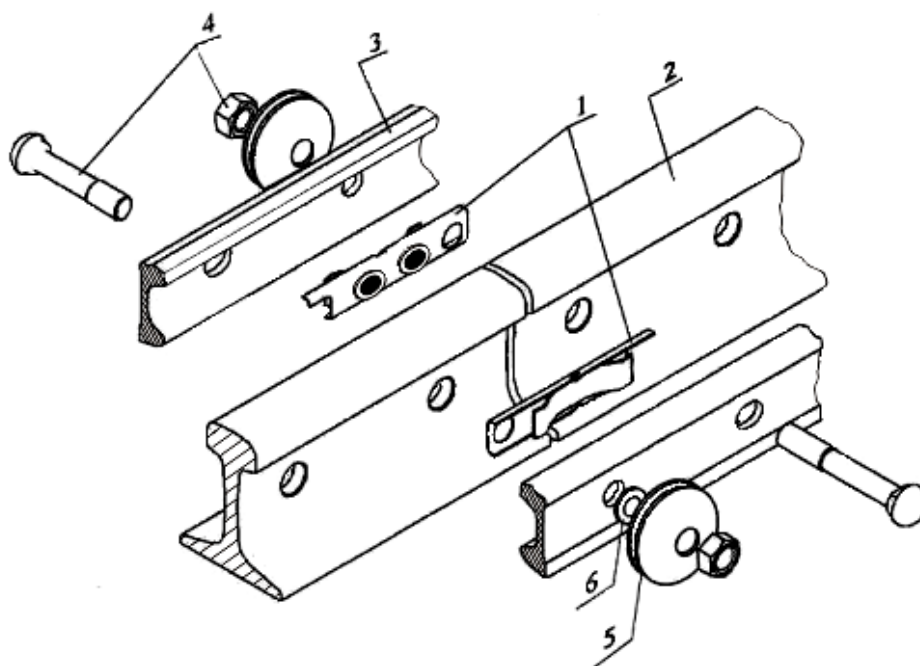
Схема монтажа рельсового стыкового пружинного соединителя.
